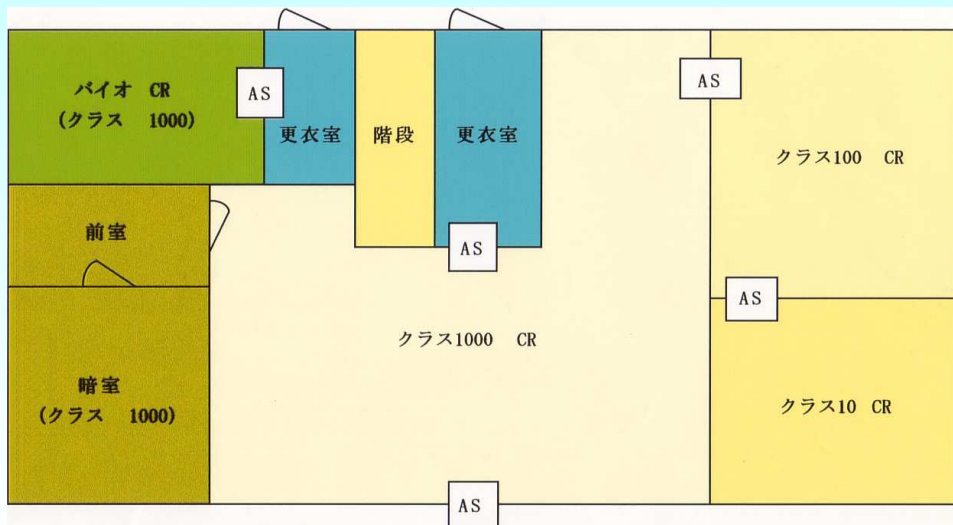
放射化学実験棟 1階平面図 1:356 (変更後)
